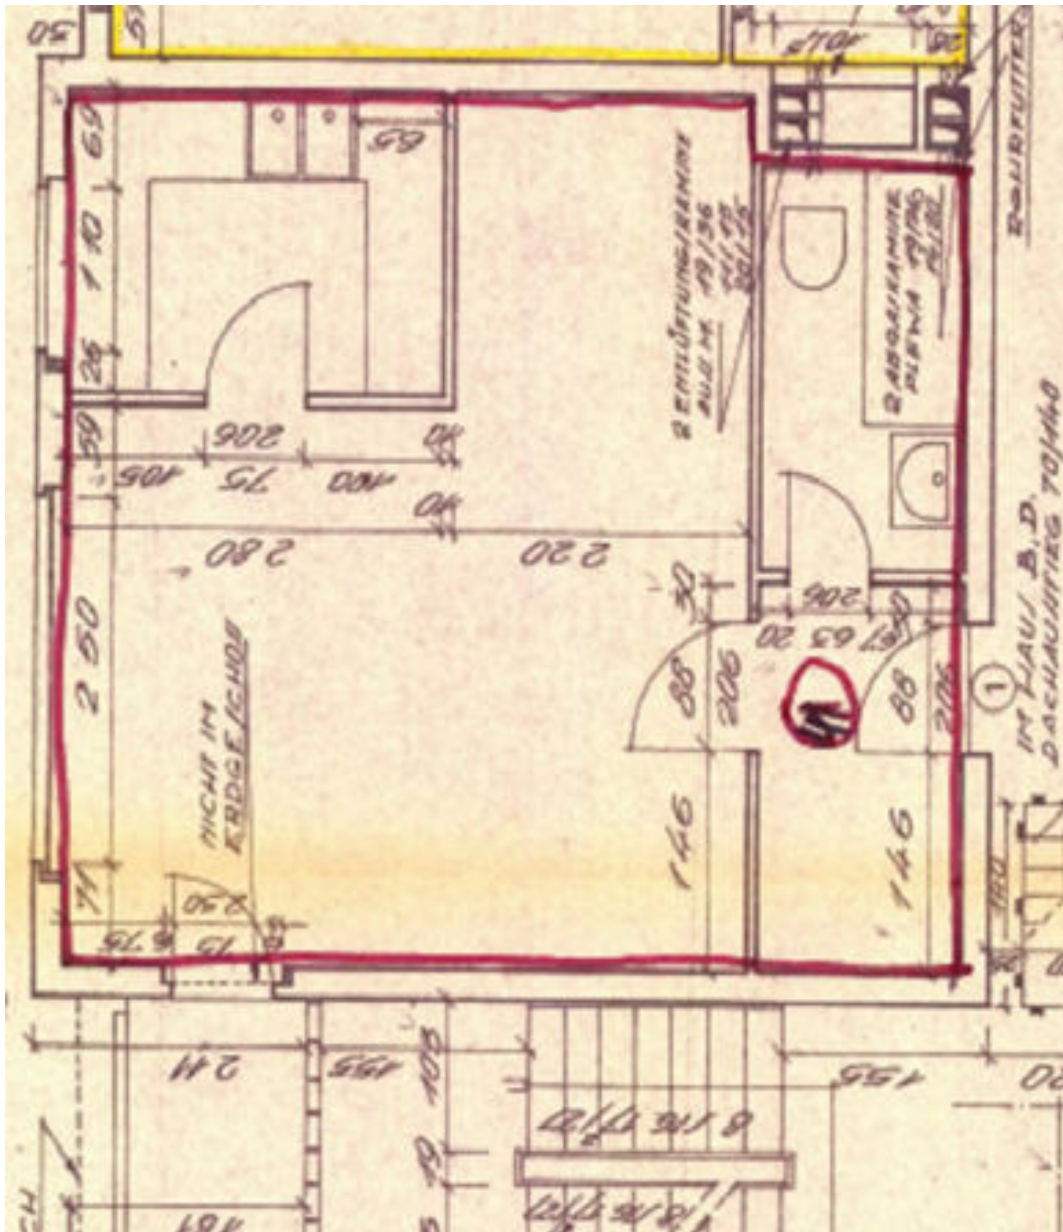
Übersicht, Grundriss Ein-Zimmer-Wohnungen 306 - 806 (ohne Maßstab); Quelle: Hausverwaltung
